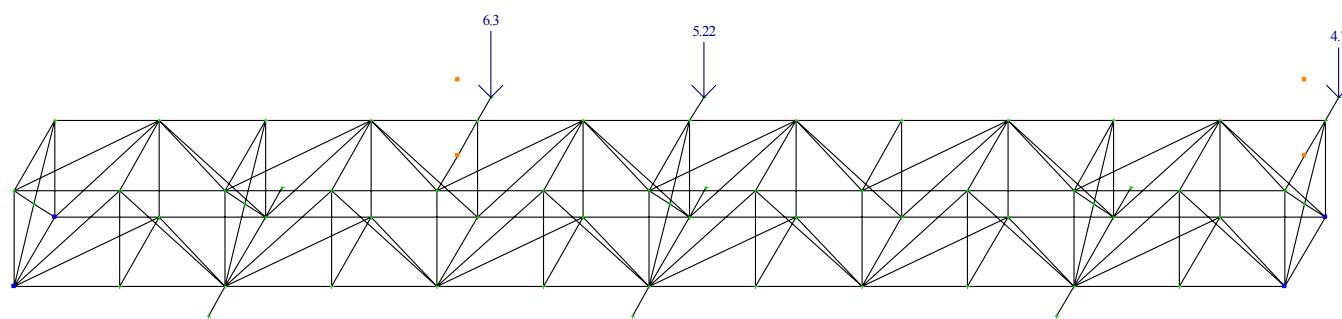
Вертикальные нагрузки от проектируемых трубопроводов
